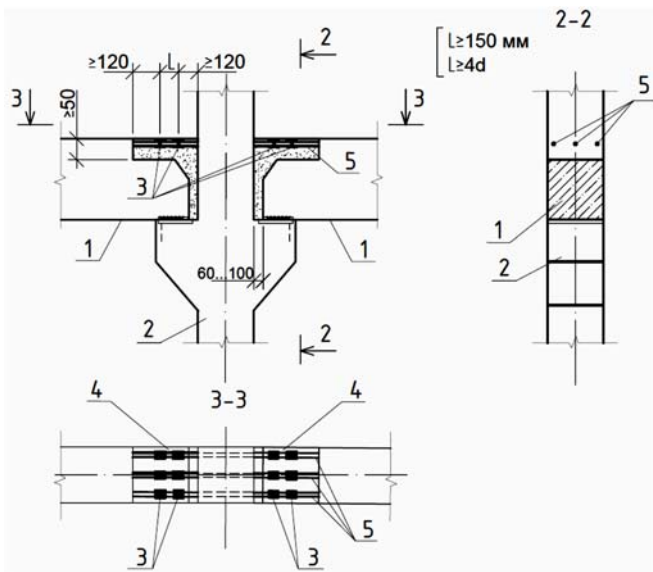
Конструкция узла опирания ригеля на колонну в унифицированном каркасе (серия 1.420-12, ранее ИИ-20):
